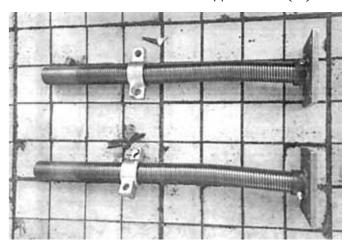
Образцы после испытаний Fig. 3. Samples after testing
